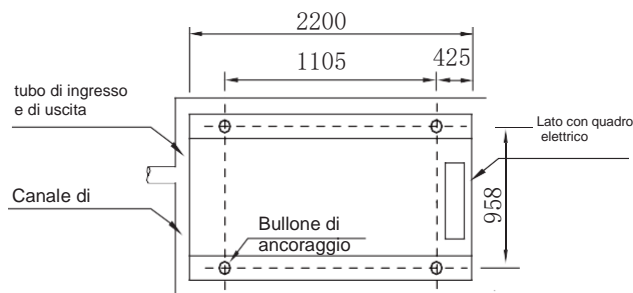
Vista dall'alto di un diagramma schematico delle dimensioni dell'installazione SCV-600EBH
